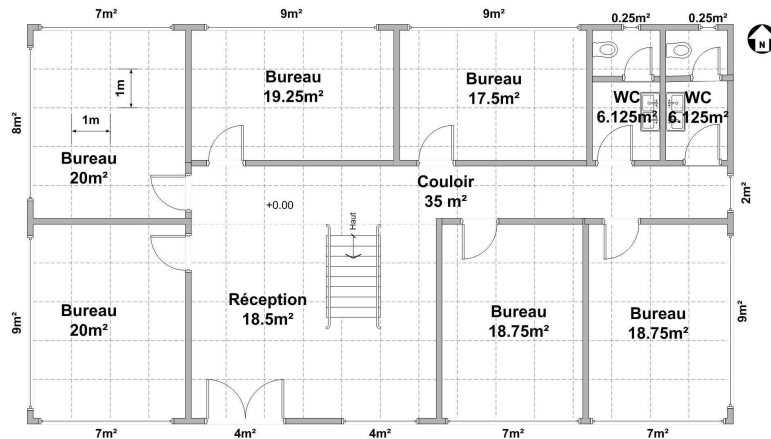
Plan du RDC du bâtiment Beethoven
